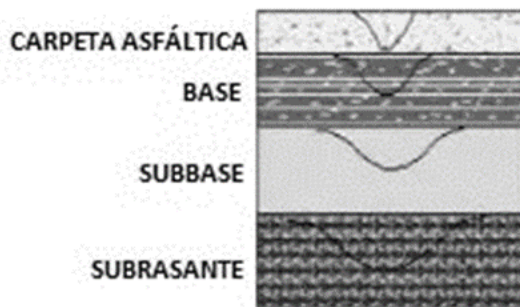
Estructura tipo de pavimento flexible (Vargas Jiménez, 2017).
